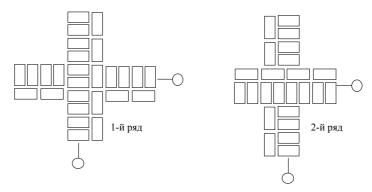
Кладка пересечений стен толщиной в 1,5 кирпича
